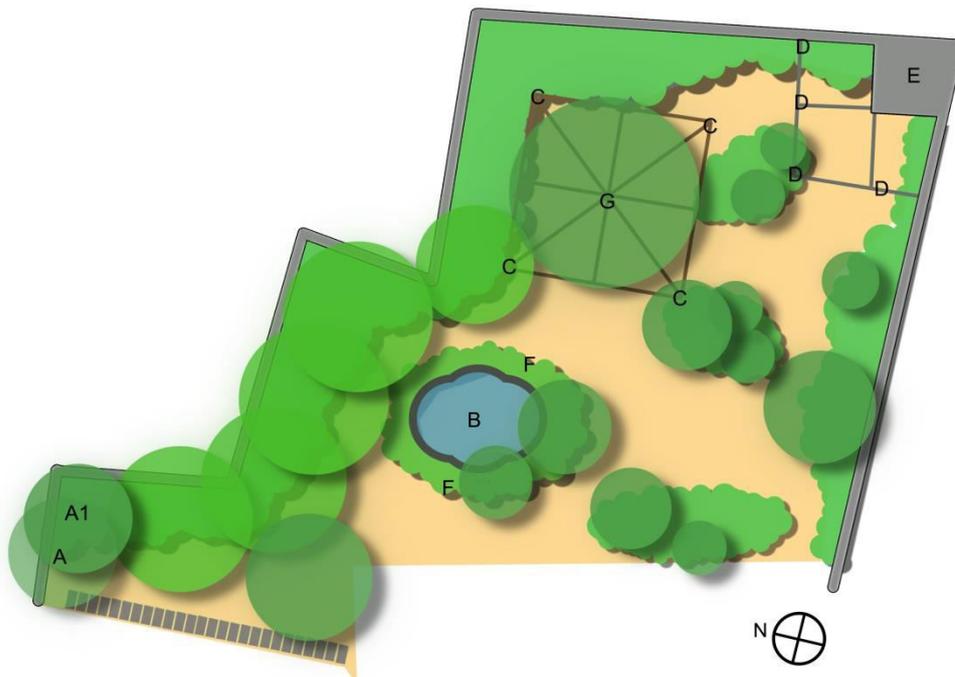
Primeiro esboço da planta de projeto proposta, enviado ao cliente. Esc:1/500
